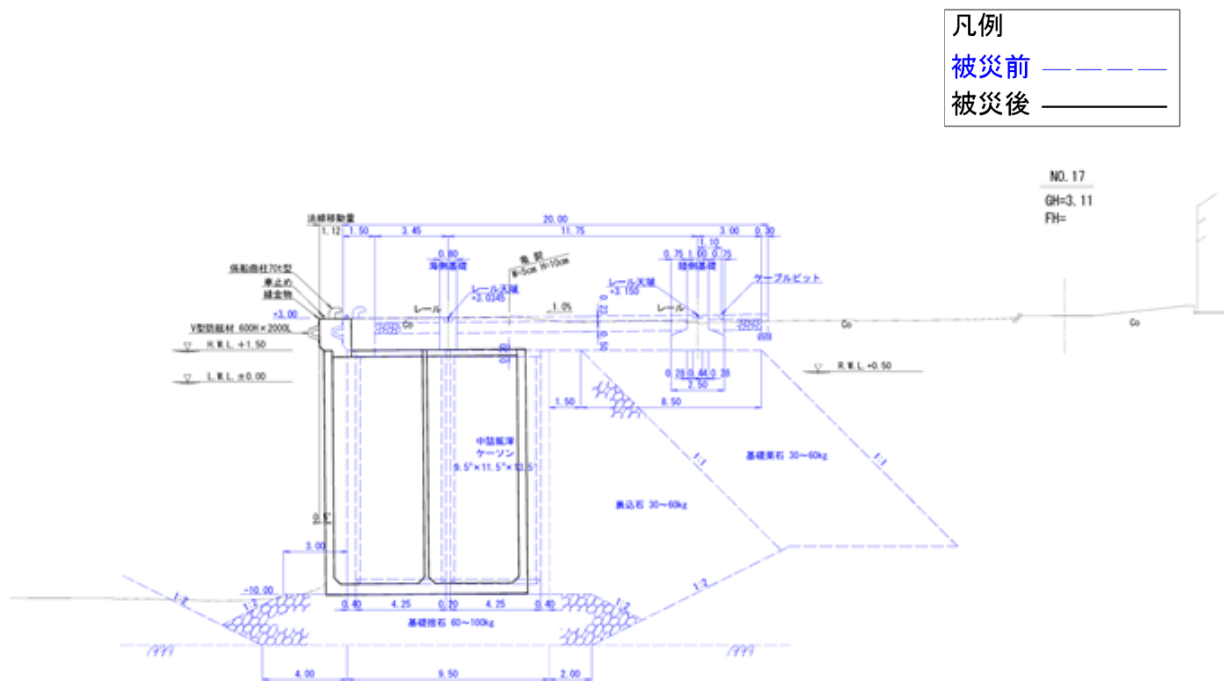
No.4 日立港区\_第1ふ頭地区 1-D 岸壁 (-10.0m) の断面図 (被災前・後)
